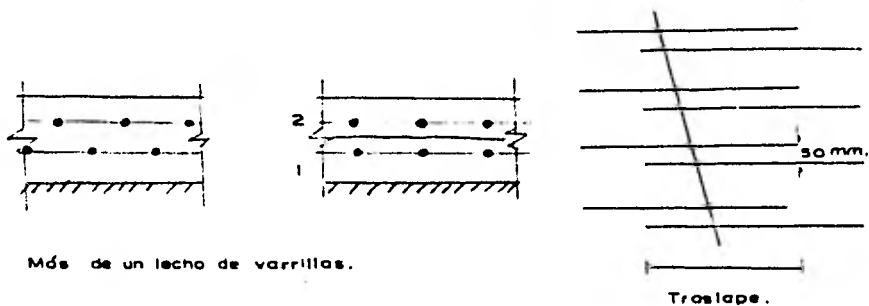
Forma correcta de colocar el acero de refuerzo en el concreto lanzado .
